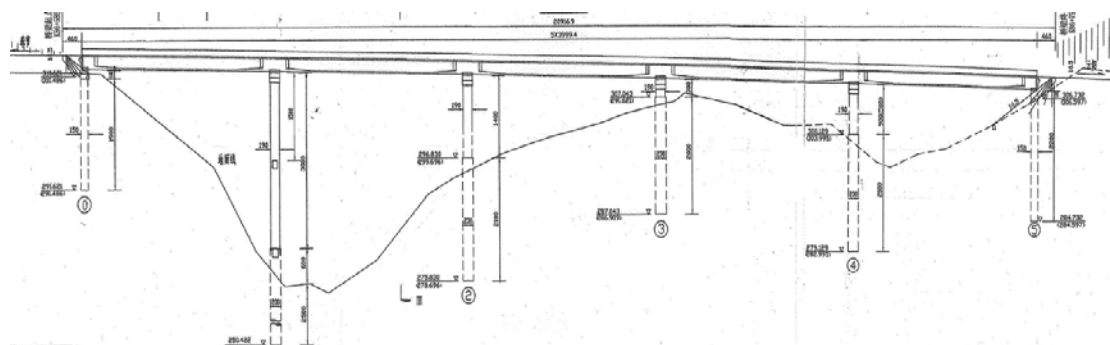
杨柳坪大桥立面图（单位：cm）
